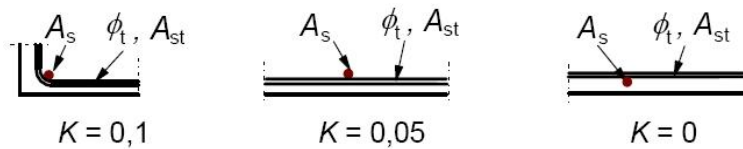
Valor do parâmetro K para vigas e lajes [68]
